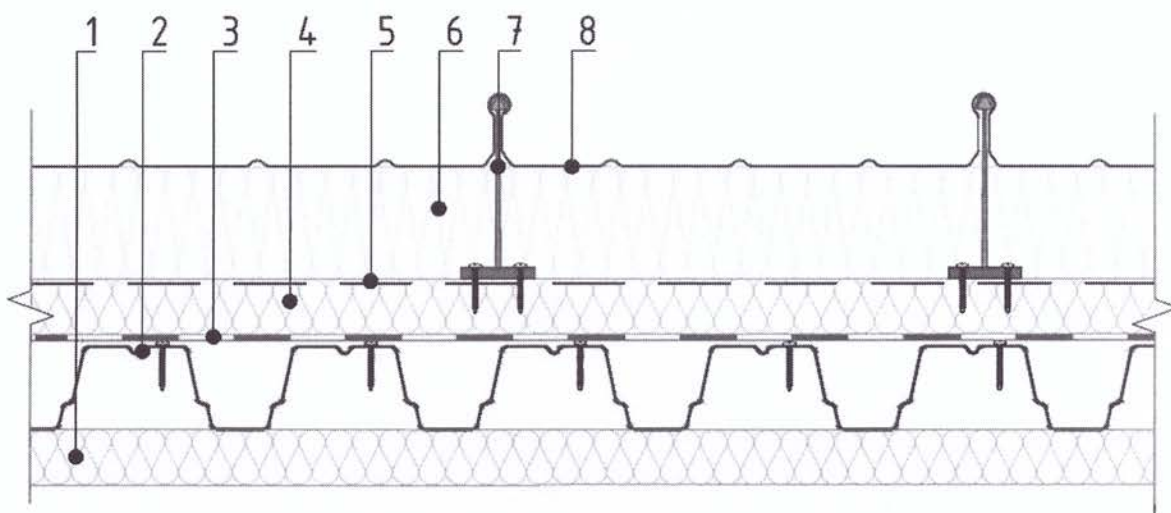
Кровельная система для зданий I-й степени огнестойкости с огнезащитой нижнего пояса профилированных листов
